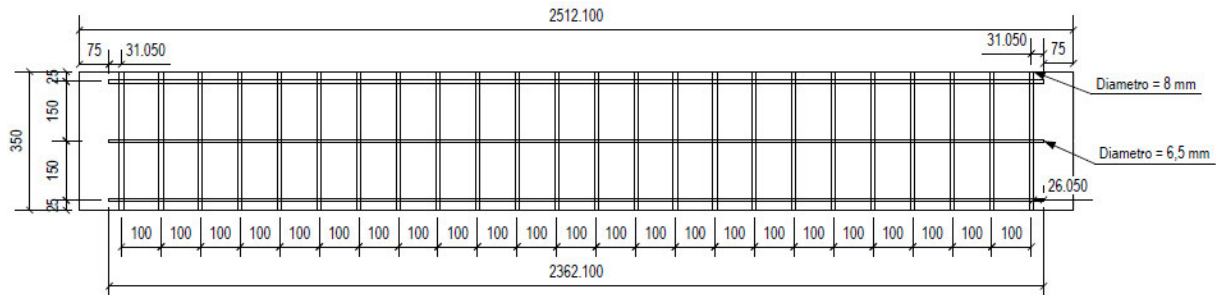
Disposição em planta da armadura realizada no *Software Tekla Structural*.
